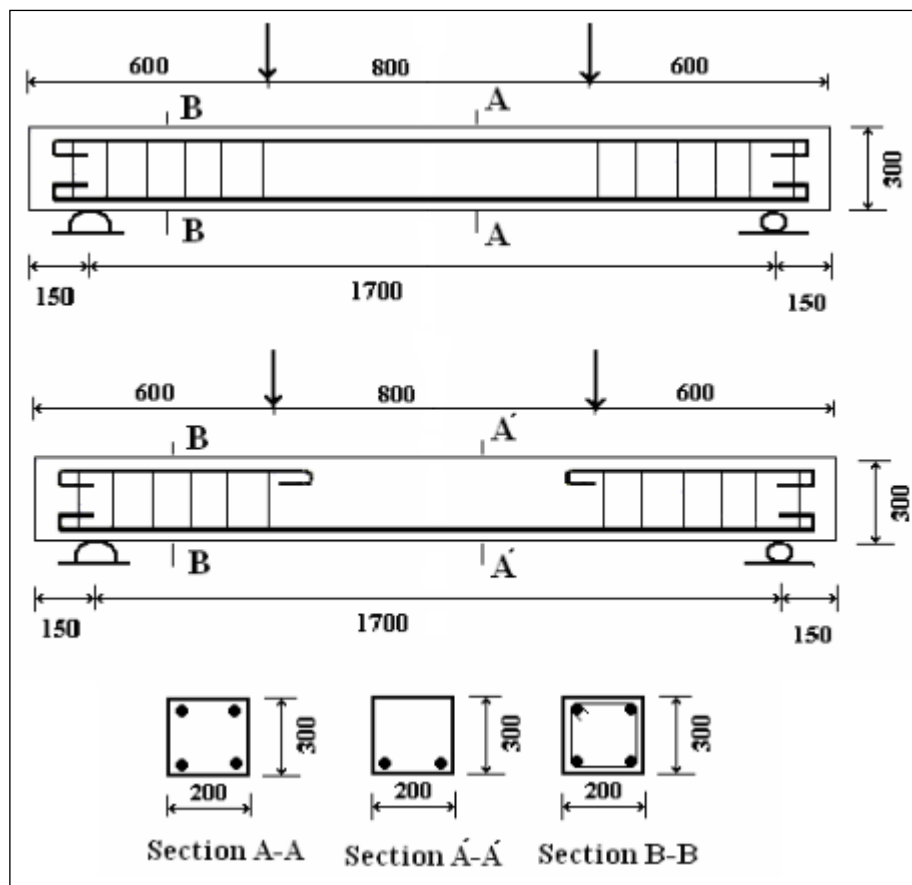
Détails des poutres testées (Maghsoudi et Bengar (2006)).
